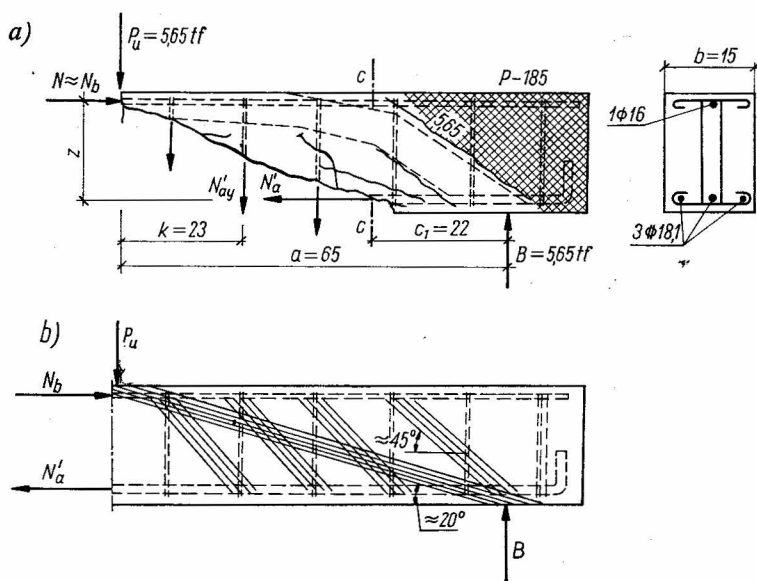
Zone d'appui de la poutre P-185 en état de rupture : a) disposition des fissures, b) schéma des efforts
